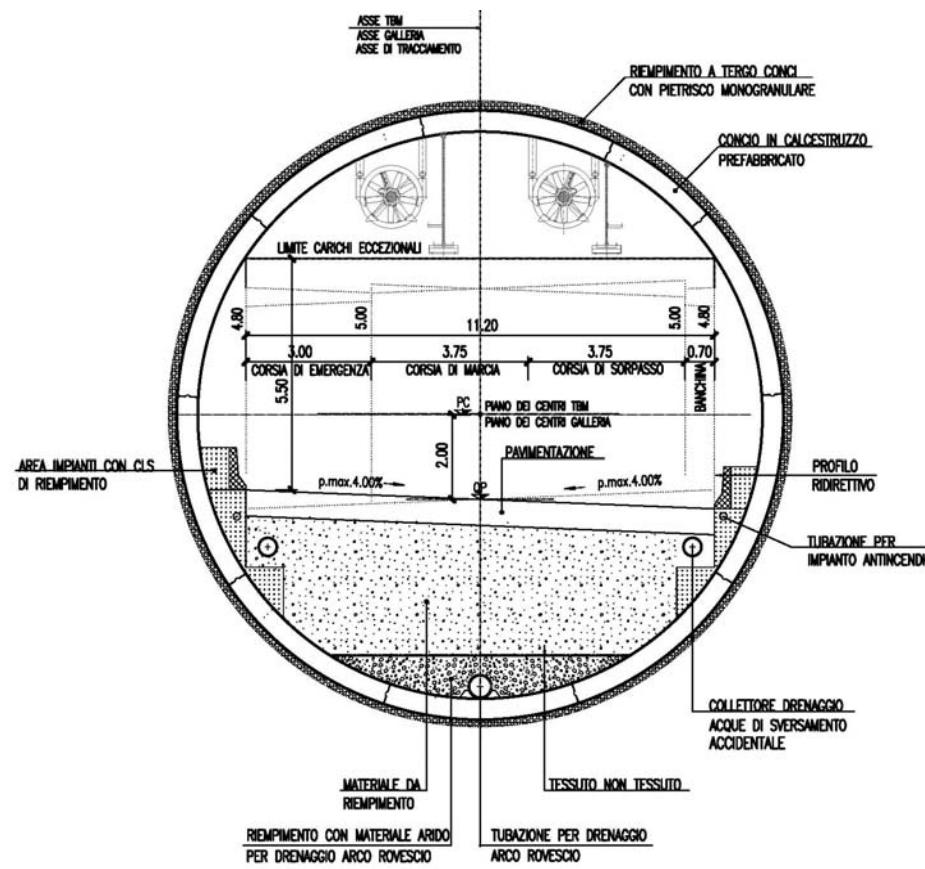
Sezione tipo in galleria naturale con scavo meccanizzato
